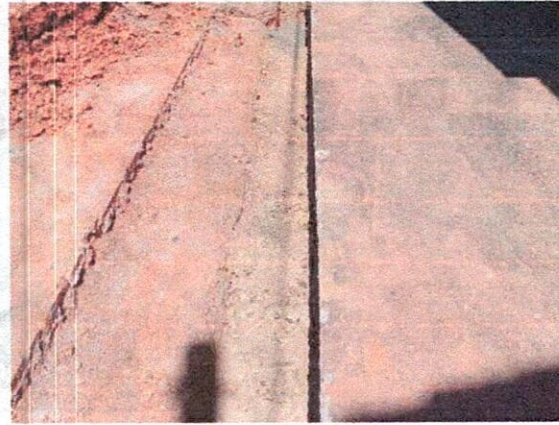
y 8: Vaciado de pavimento en calle 7 entre carreras 7 y 8.
